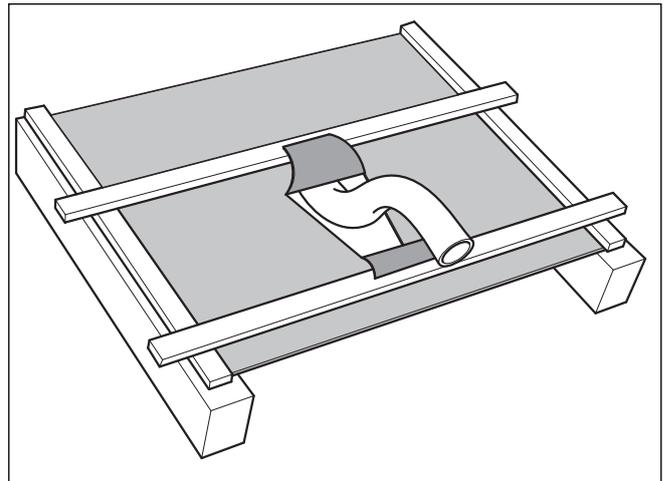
Rohr durch Unterspannbahn oder Dachpappe führen
